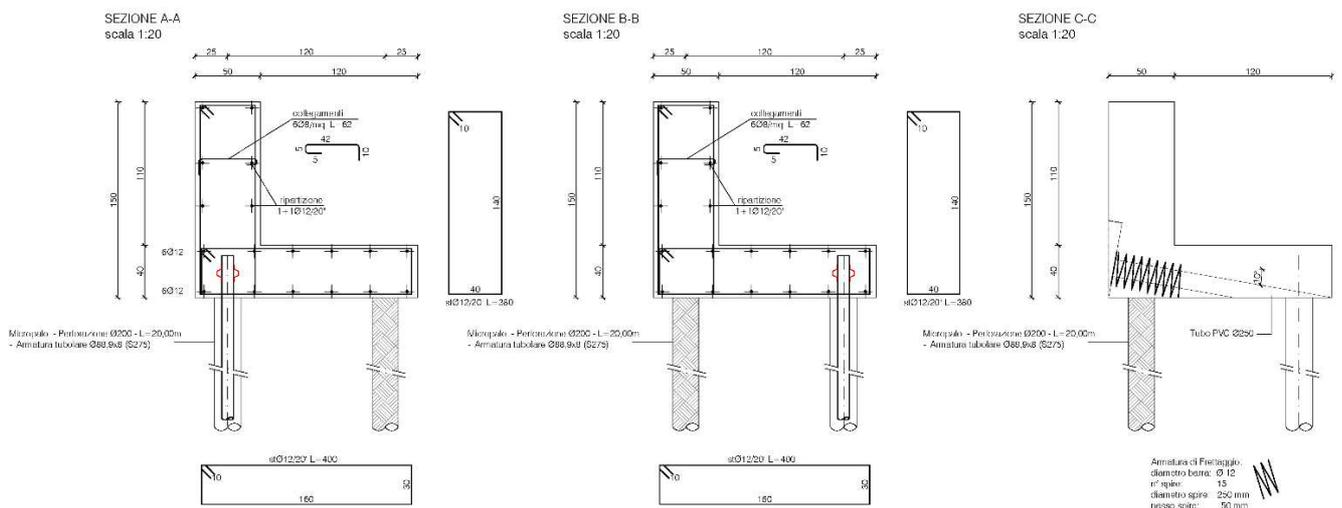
Sezione tipo dei pali e della trave dell'opera di consolidamento in banchina stradale.
